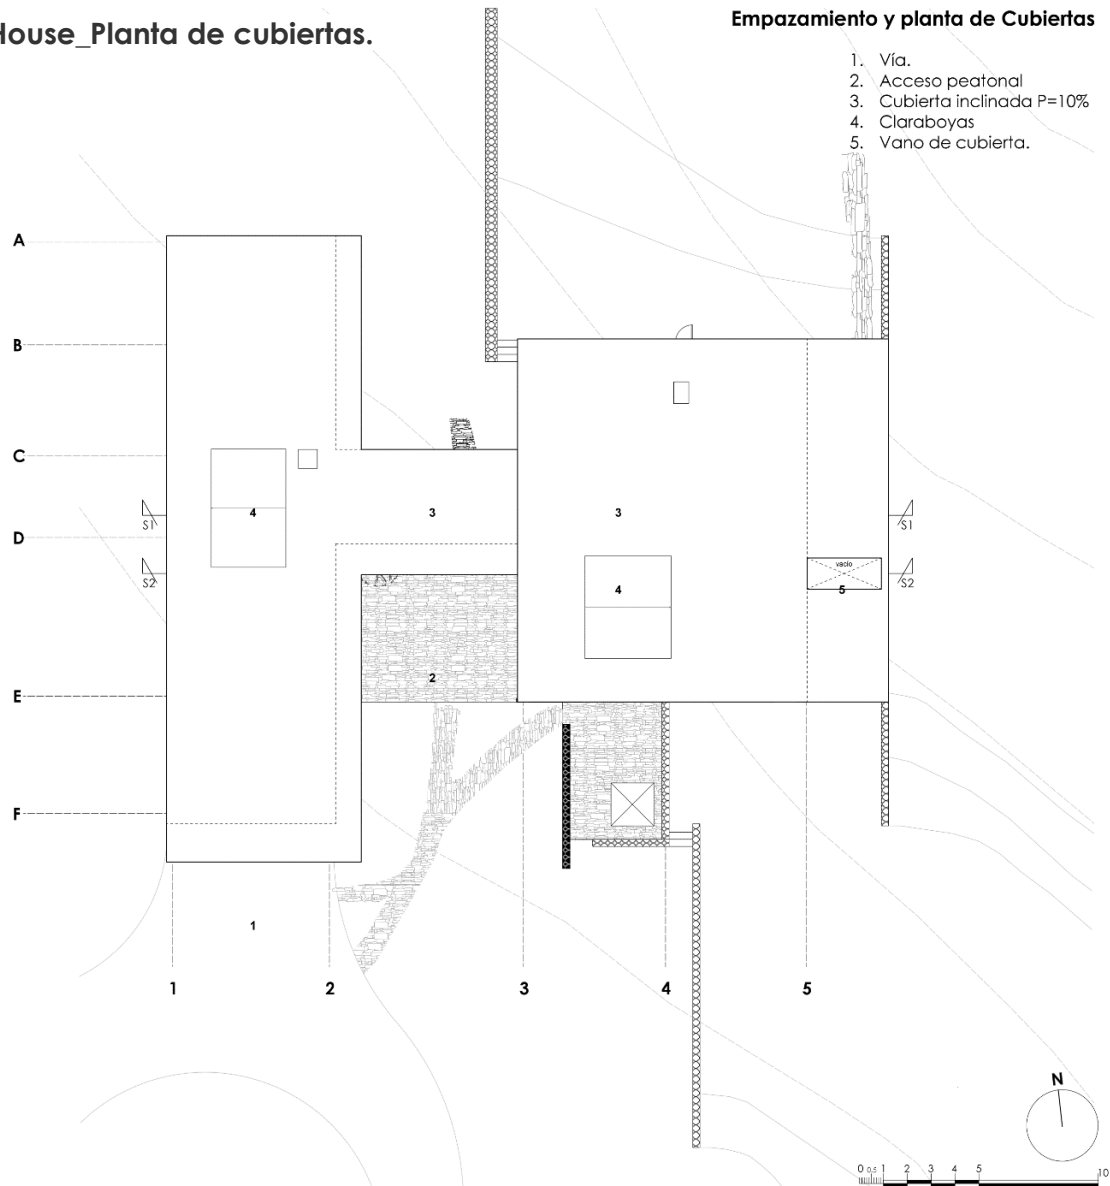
Planta de cubiertas y accesos. Fuente: Autor.
